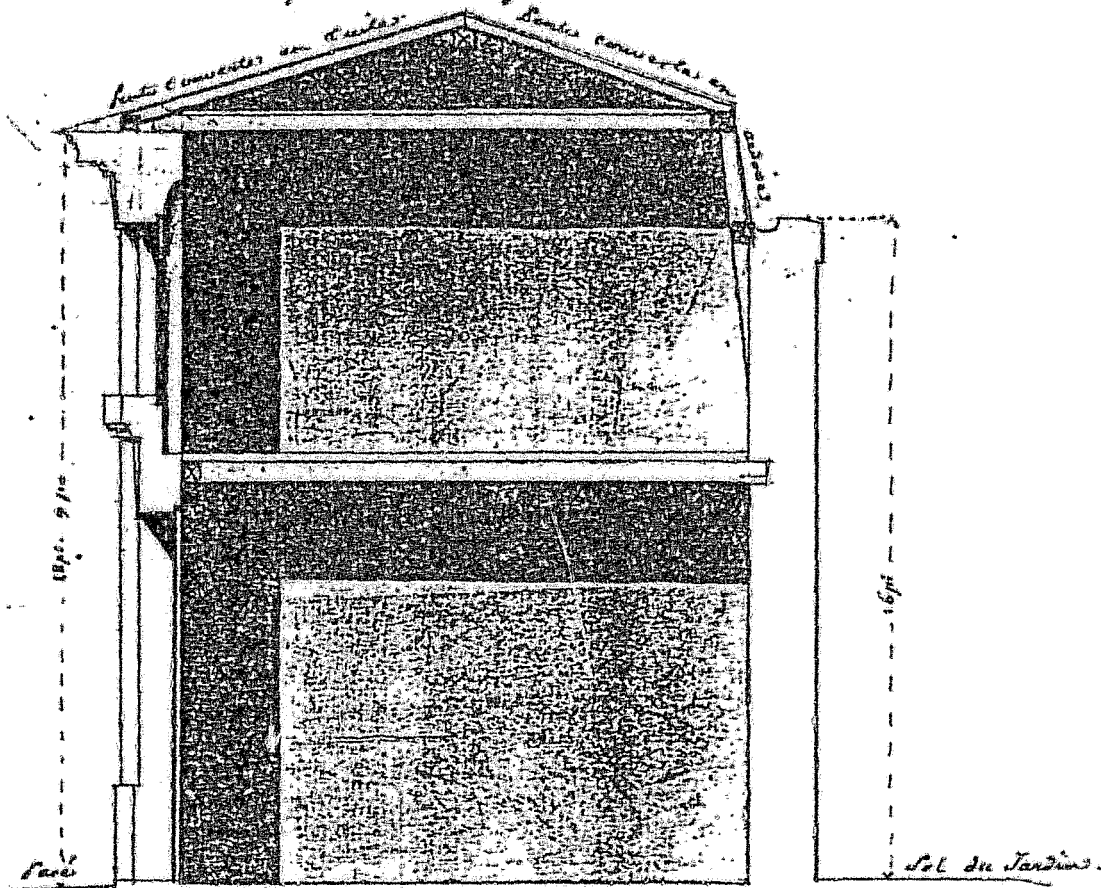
Élévation et plan d'une boutique rue Monbazou. Bonfin, 1778.
